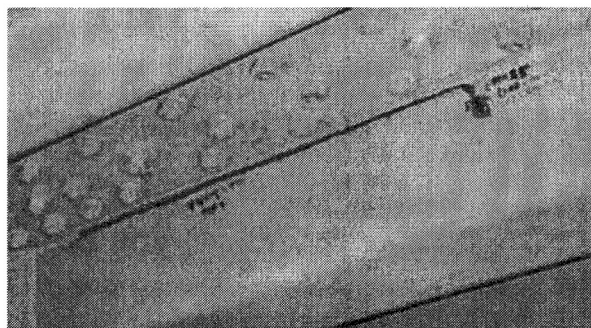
Uリブとデッキプレートとの溶接部ピン貫通き裂発生状況
